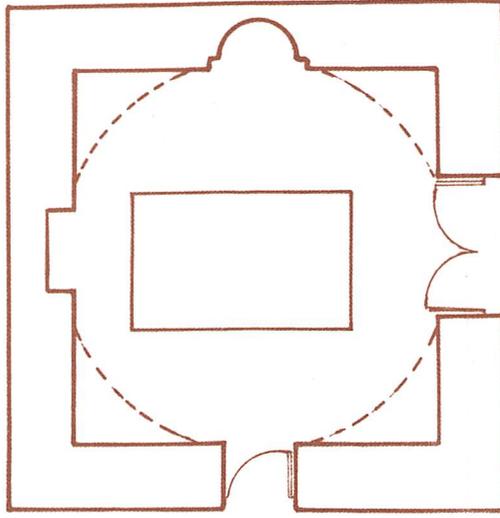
المسقط الأفقي لقبة وضريح أبو المجد بمرقص
